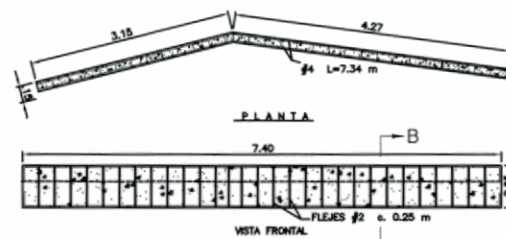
ESCALERA PROYECTADA CALLE 65D SUR
